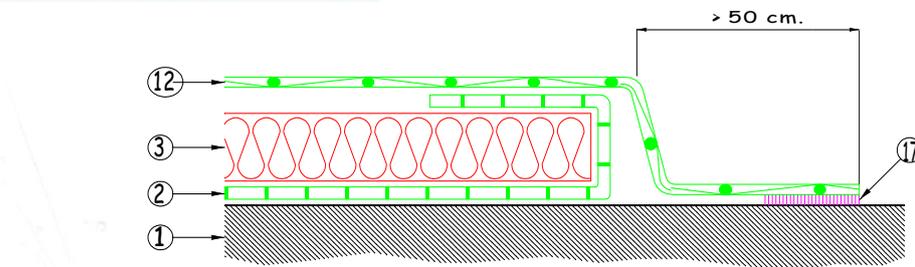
Fermeture provisoire de chantier en travaux neufs
